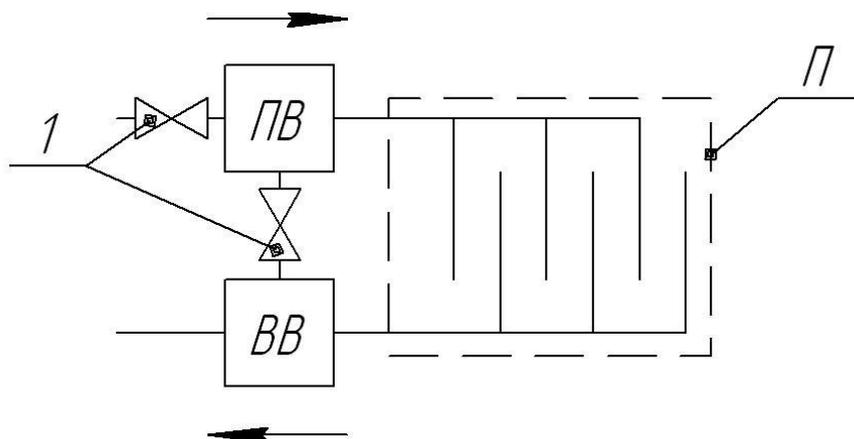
Схема приточно-вытяжной вентиляции
